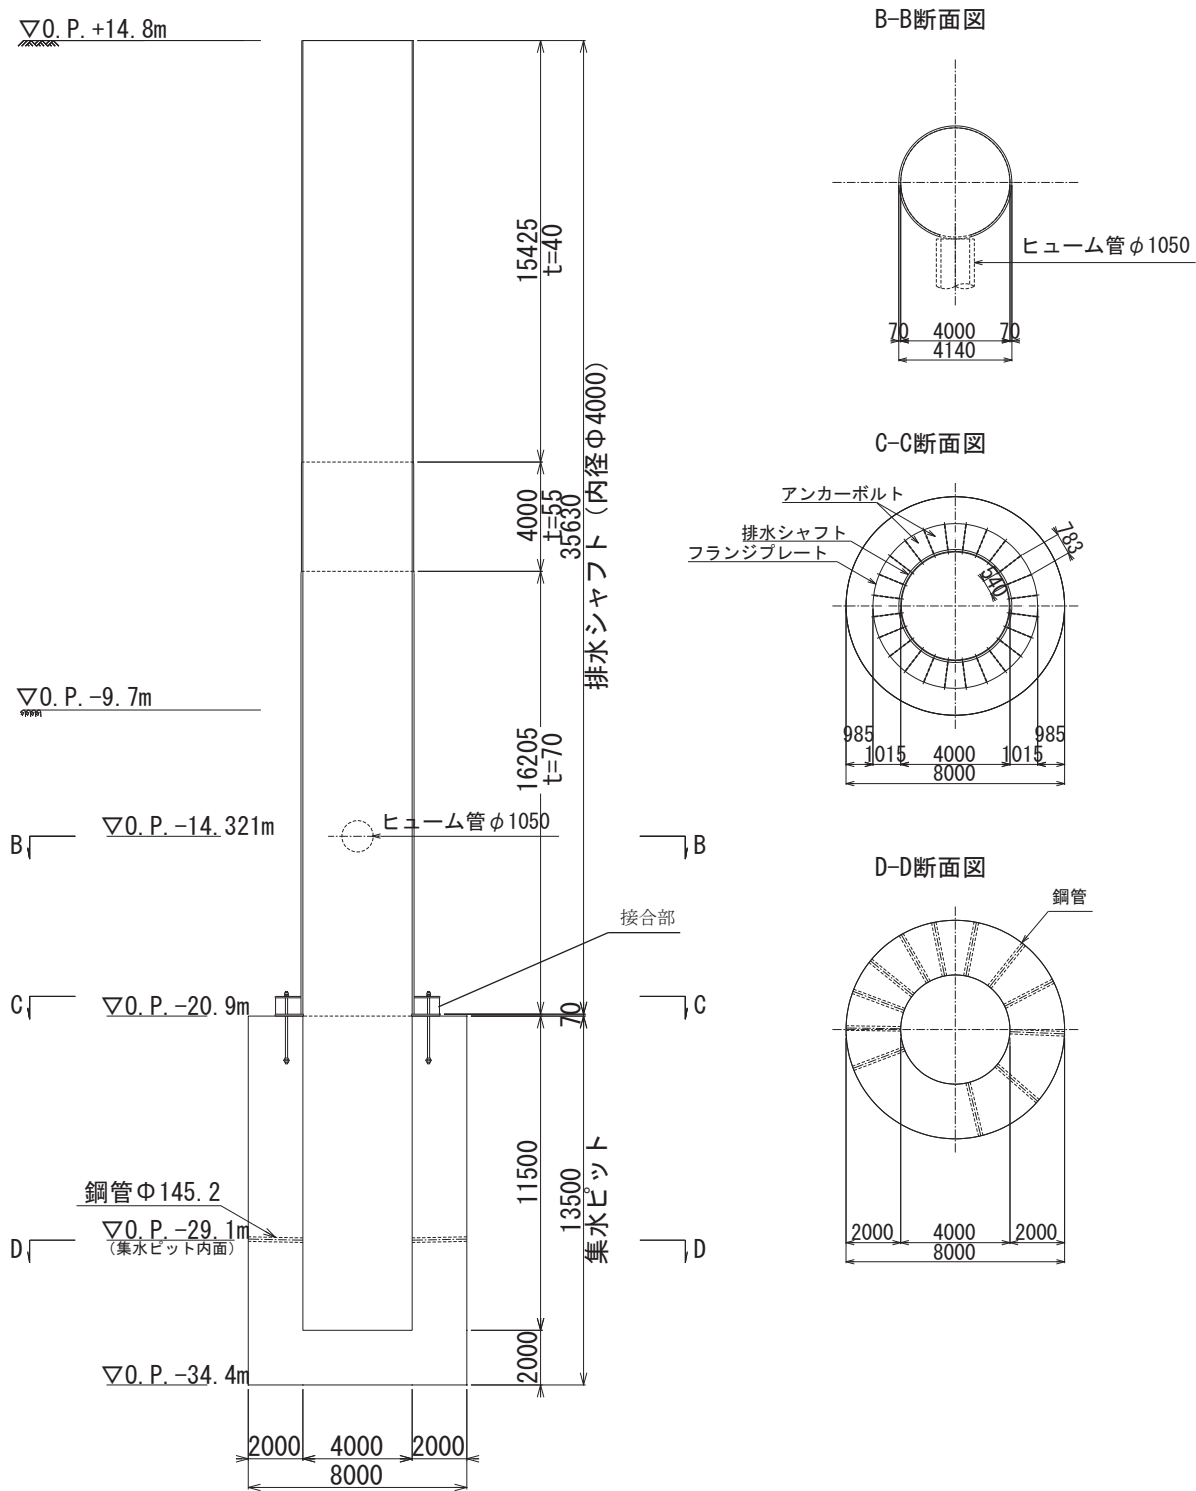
(2) No.2 揚水井戸 構造図 (単位: mm)
